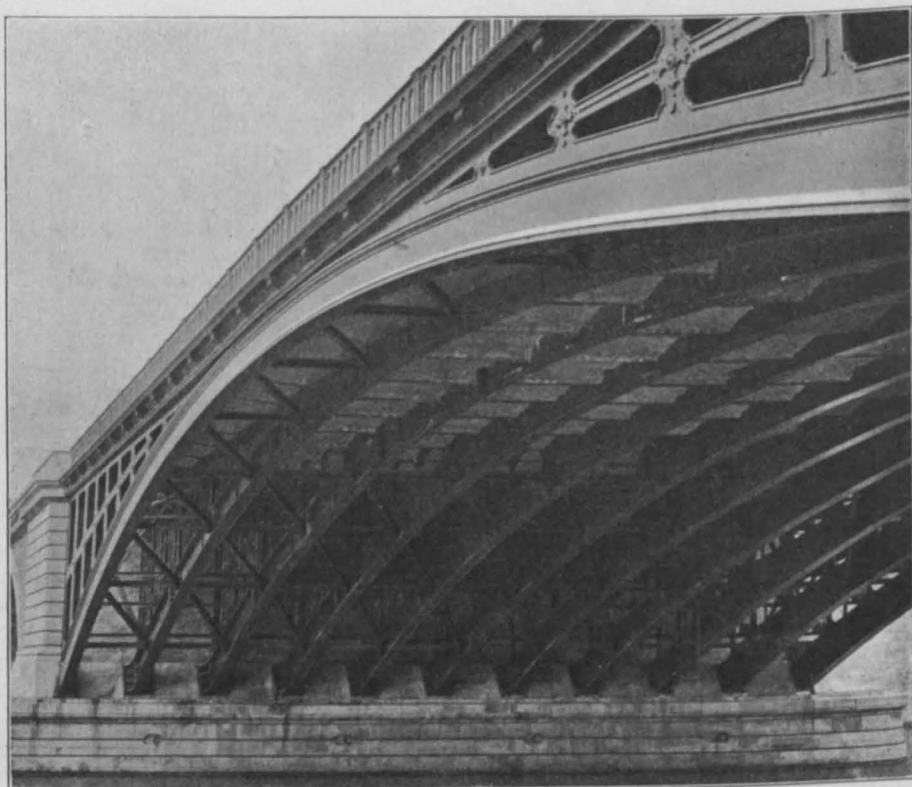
Eine Bogenöffnung der Sullybrücke in Paris.
